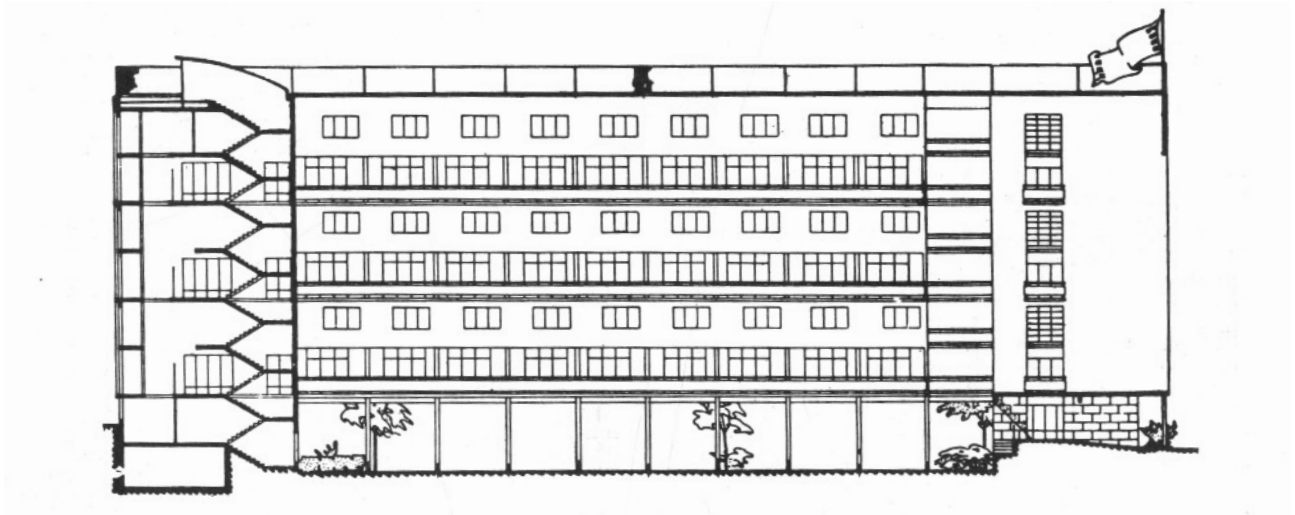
Alzado-sección. Fachada de las terrazas.
